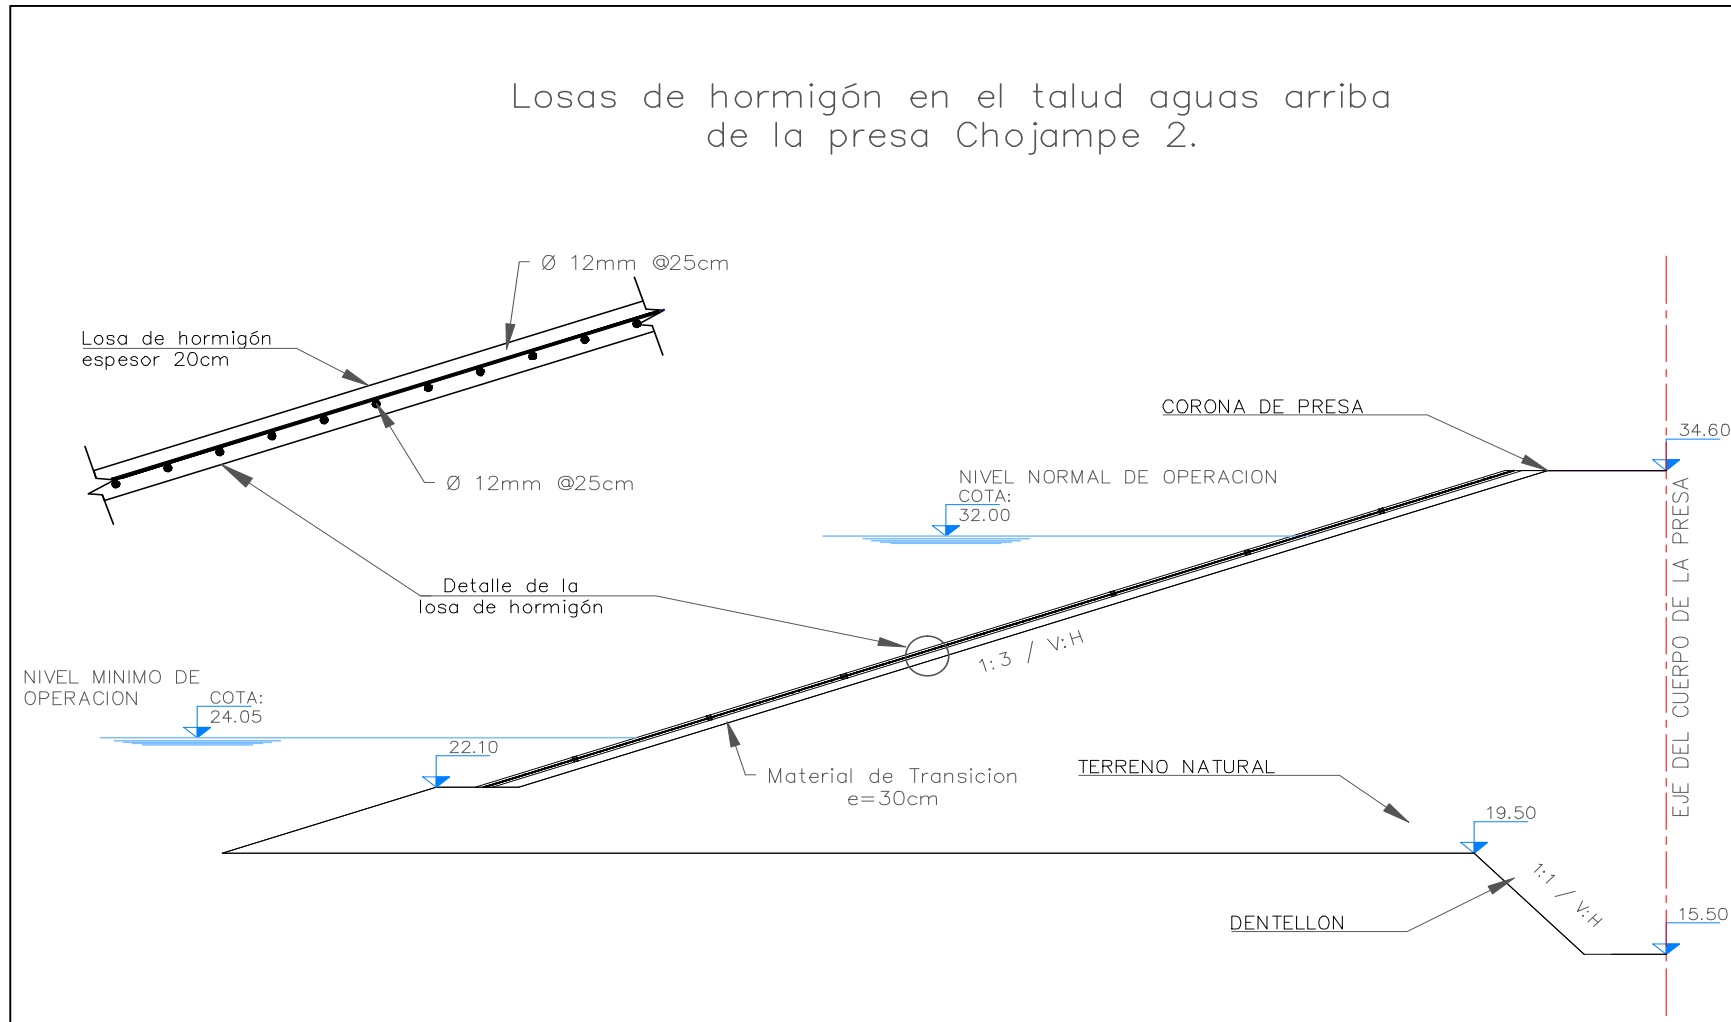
6. Losas de hormigón en el talud aguas arriba de la presa Chojampe 2
